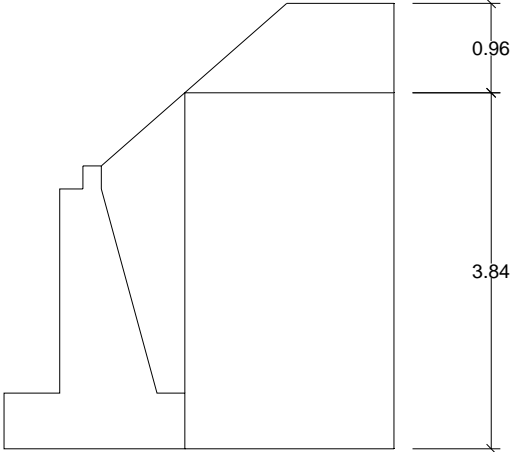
H y H1 para obtener EH y EV en Muro de contención tipo a tipo A
